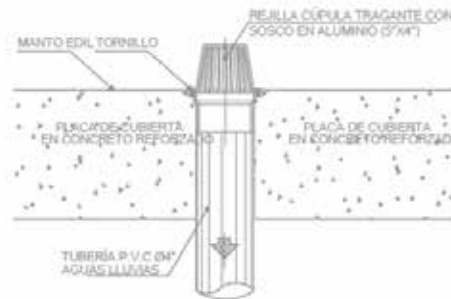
Detalle de cachimbo Fuente: La Autora (2021)
